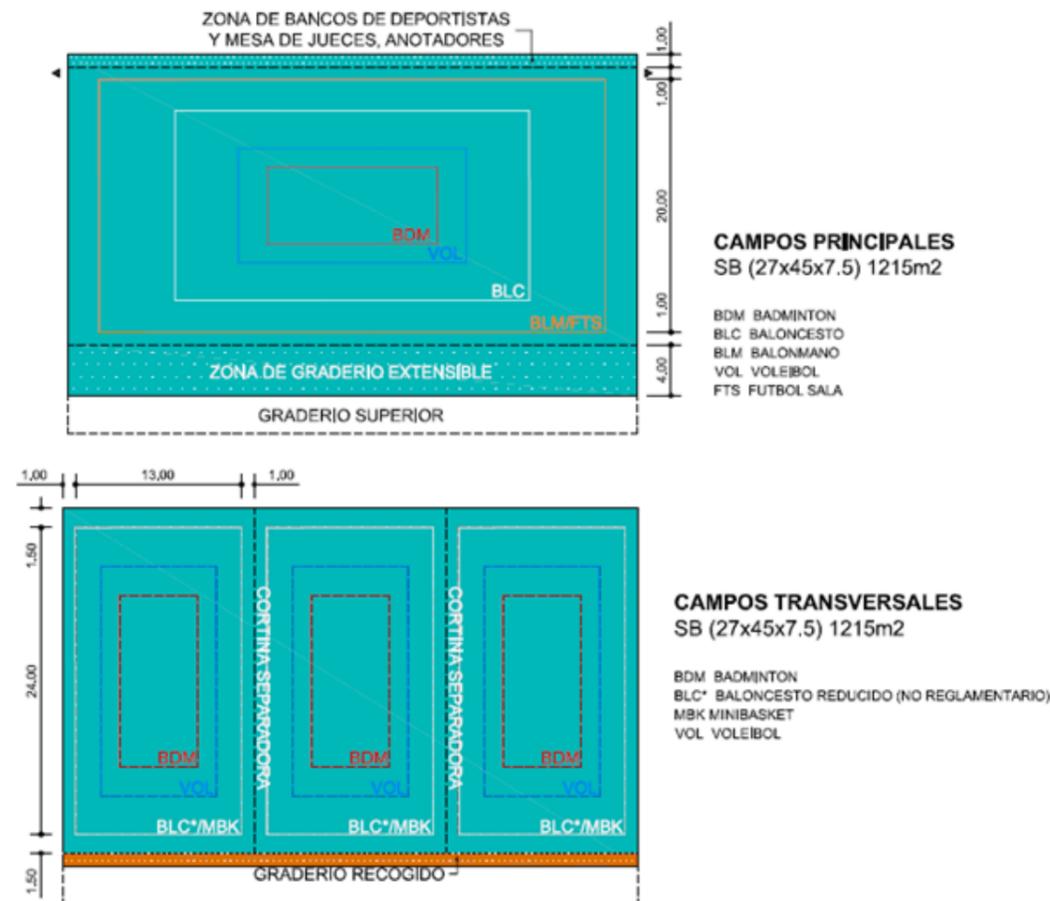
Campos longitudinales y transversales en Sala de Barrio (NIDE).
